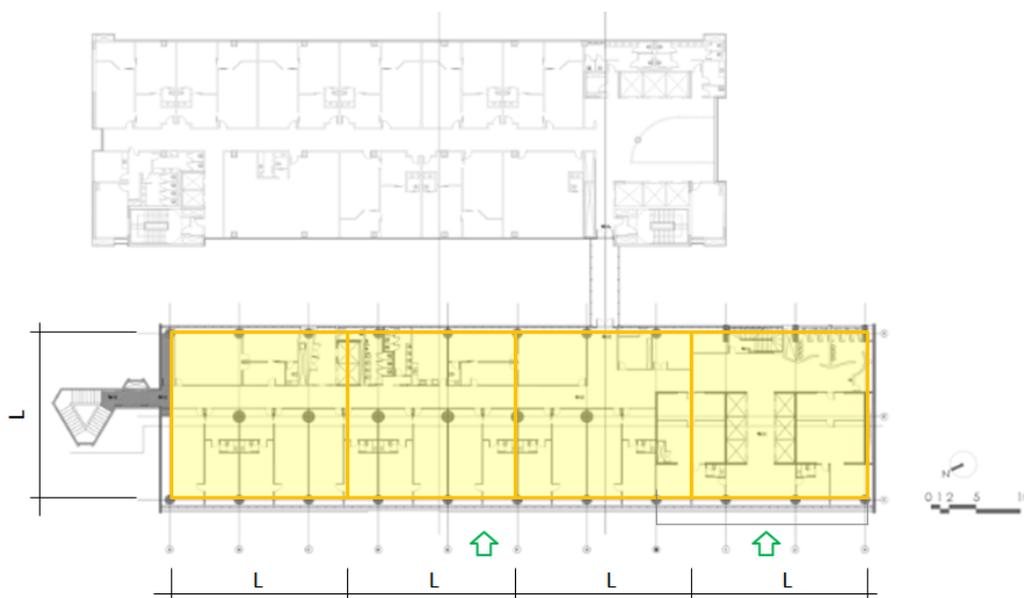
Palácio da Justiça, planta pavimento tipo com intervenção gráfica da autora.
